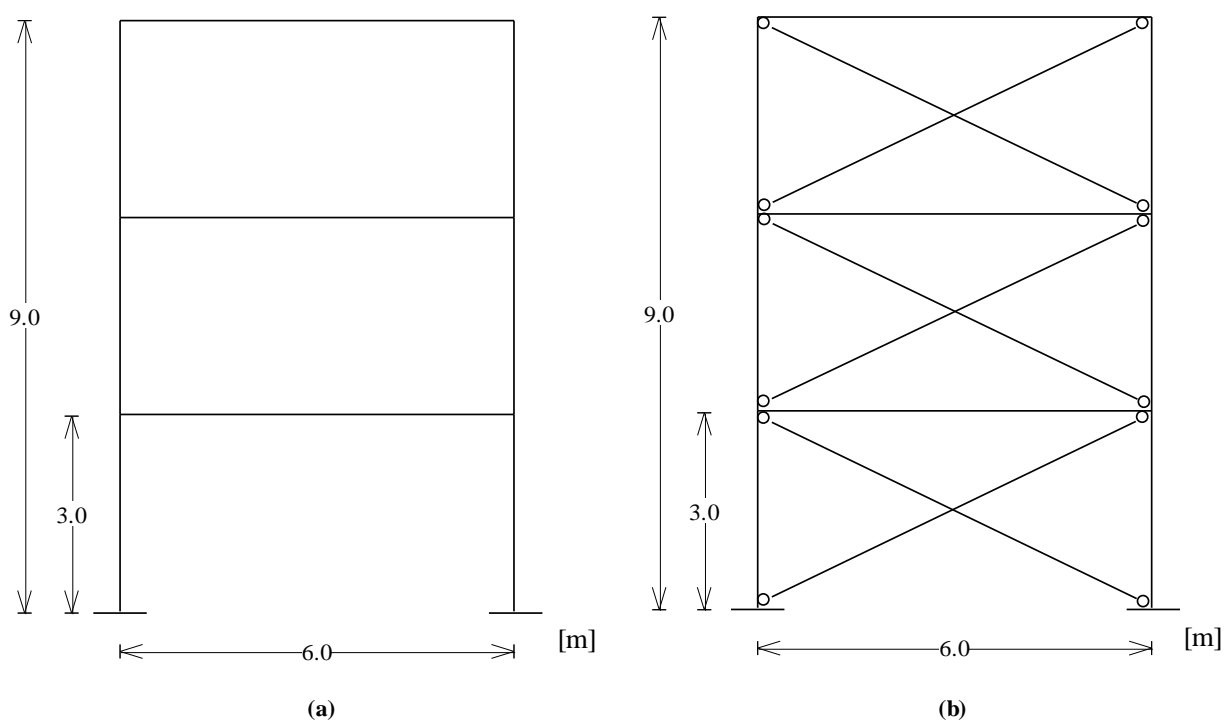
Pórticos de Betão Armado de 3 pisos: (a) não contraventado (b) contraventado.
